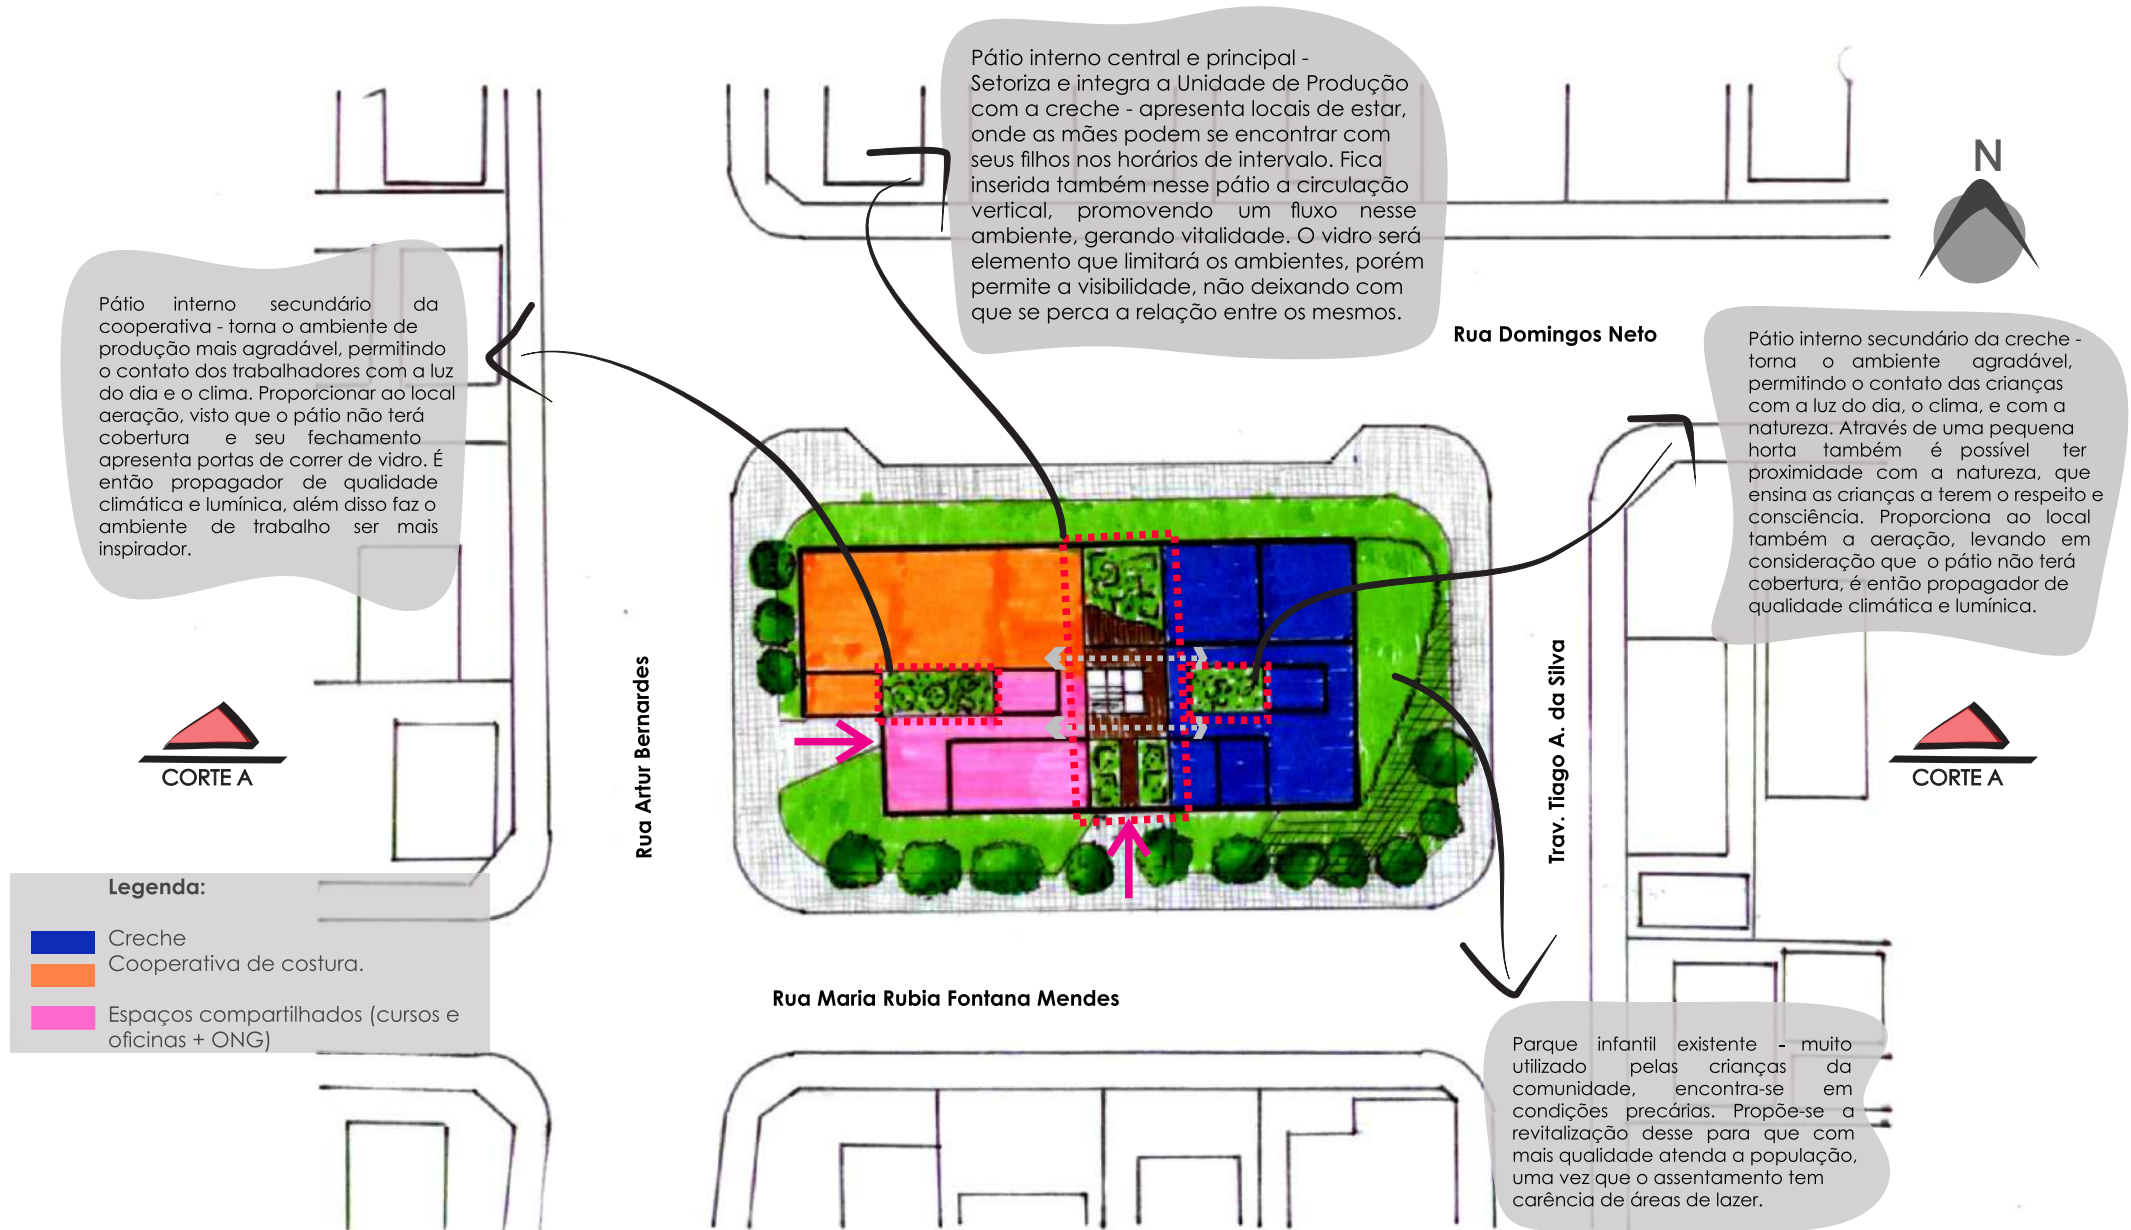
Planta baixa esquemática setorização / compartimentação
